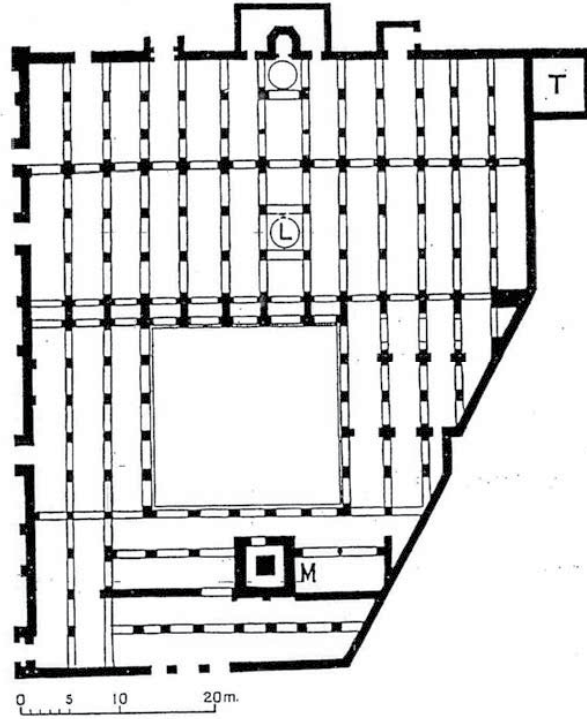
جامع ندرومة، مسقط أفقي، عن:
